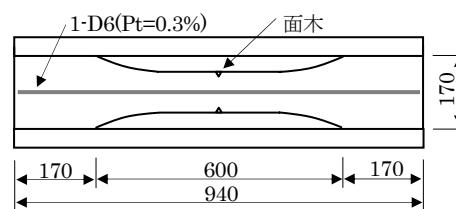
拘束乾燥収縮ひび割れ試験体の概要(単位:mm)
